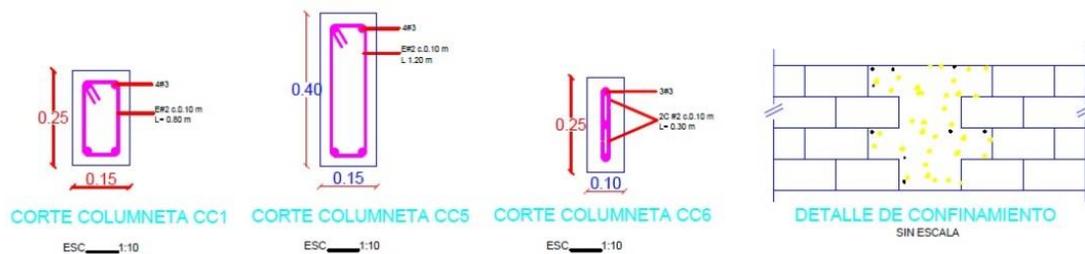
Detalles de Columnas y Mampostería Segundo Nivel. Fuente Diseño Ing. Carlos Ariel Hurtado.
